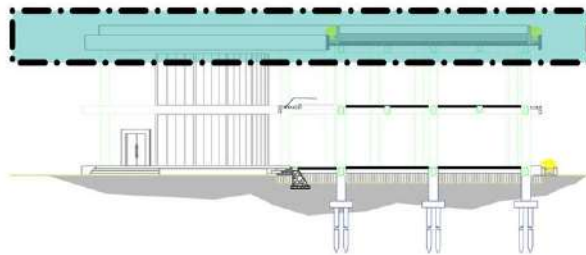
24. Konsep Struktur Atas Pada Bangunan Observatorium.
